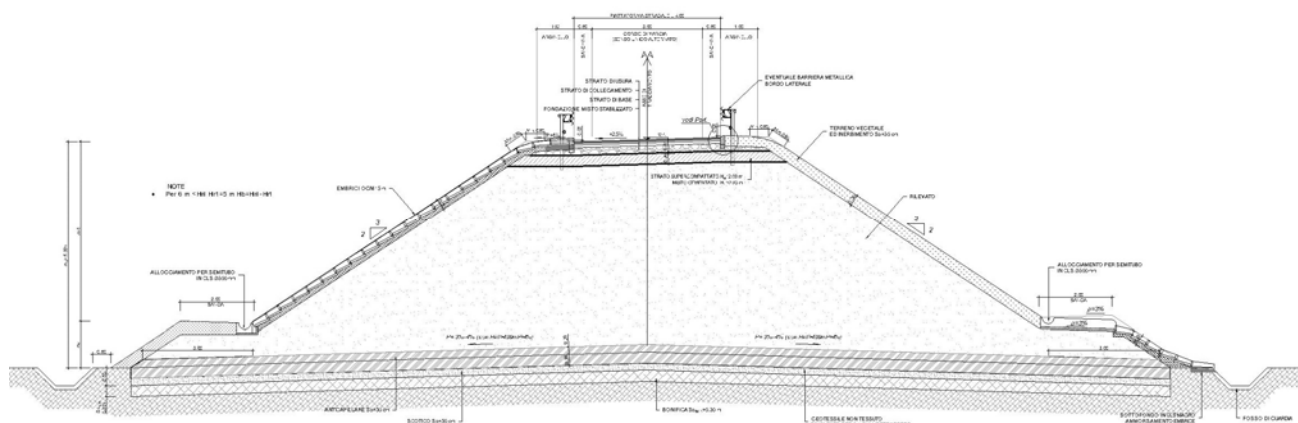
sezione tipo in rilevato $H_{ril} > 6.00$ m
